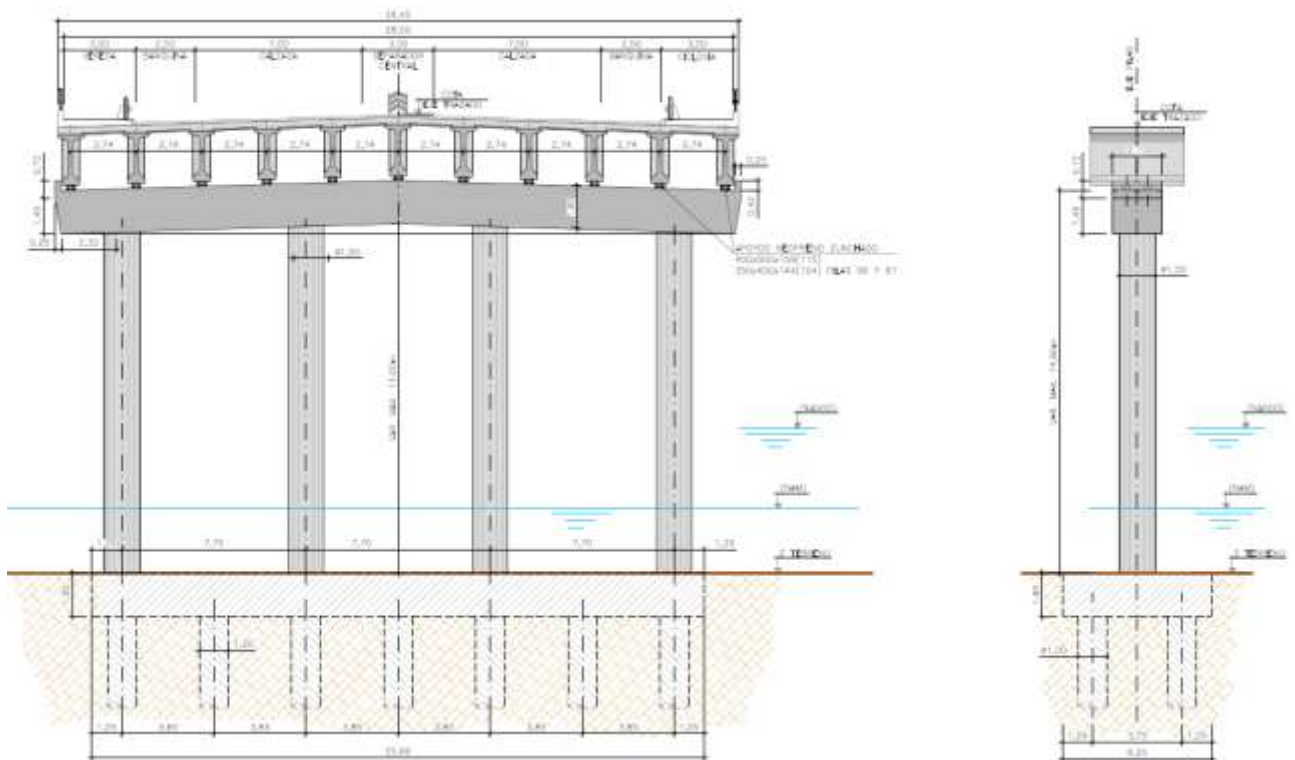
Pila pórtico Tipo 2, para apoyo de tablero de calzada doble.
